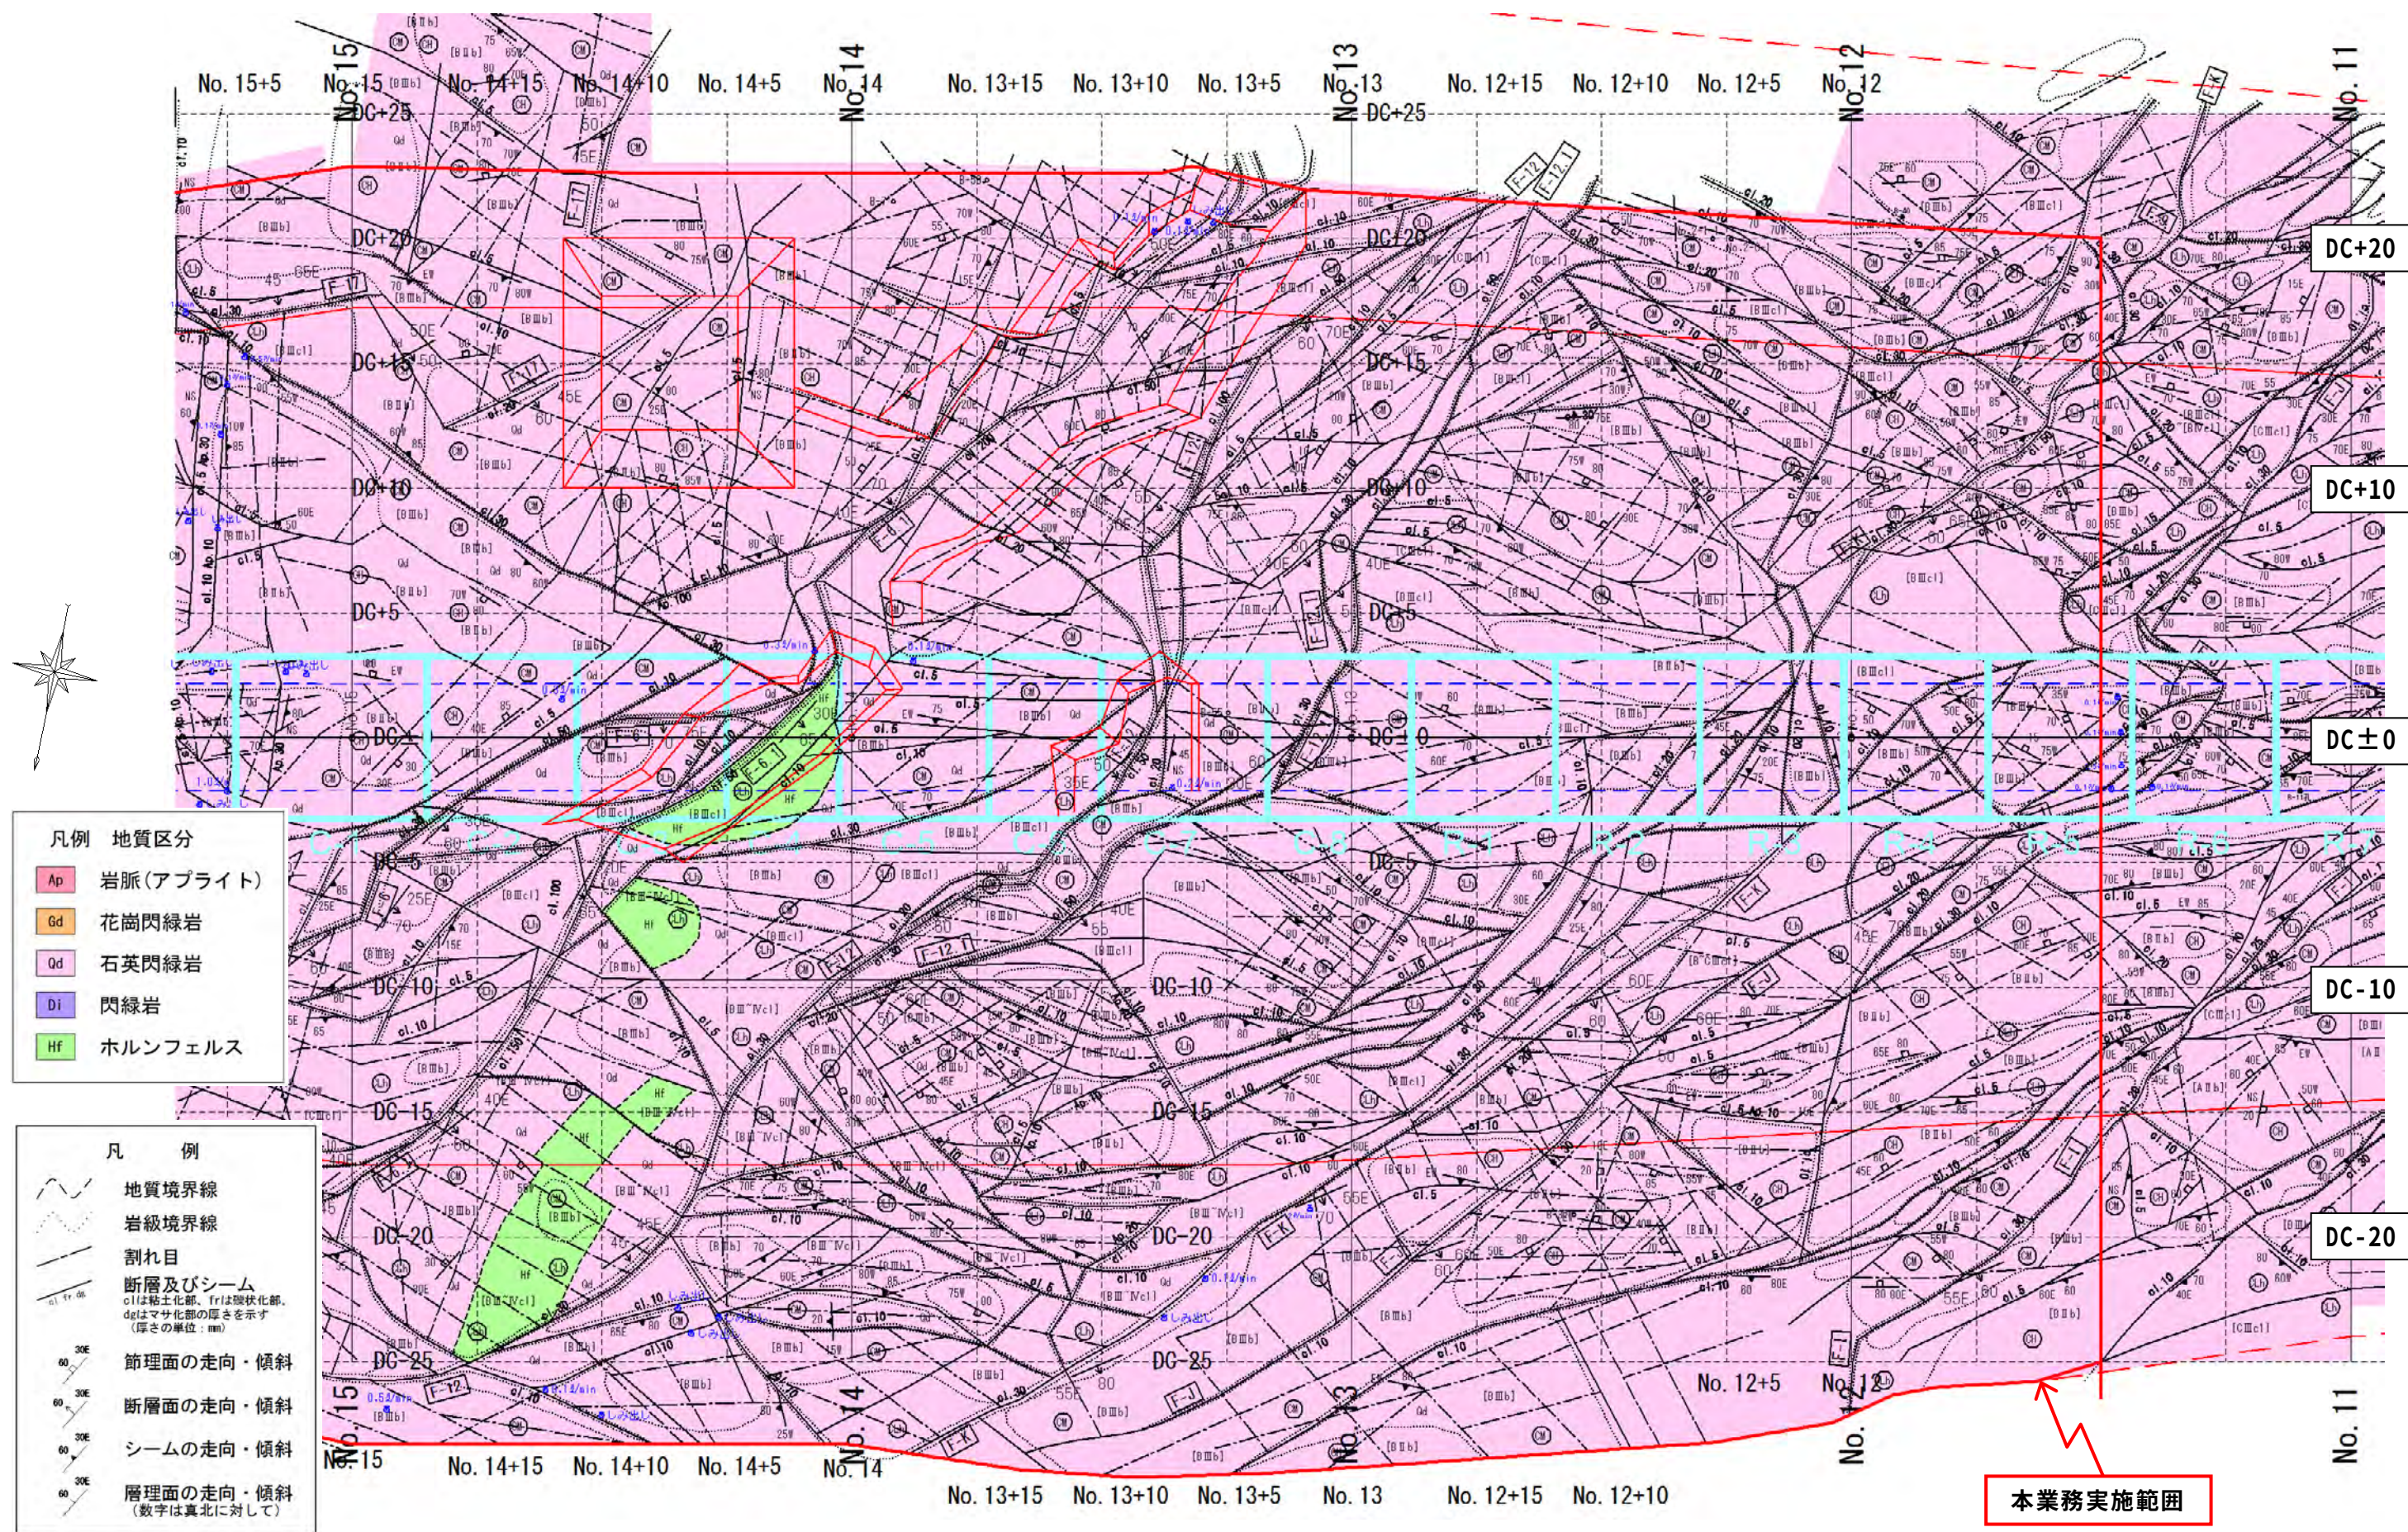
岩盤スケッチ平面図 (地質区分、河床部～右岸部)
